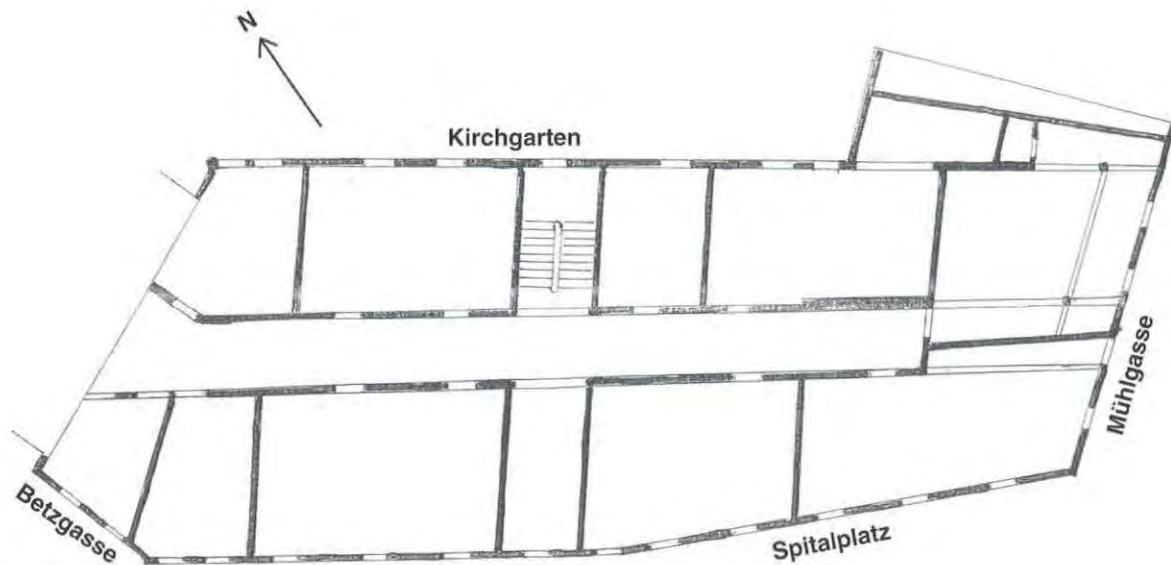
Pfründhaus 1916 – Grundriss 2. Stock (Bezirksbauamt Ludwigsburg, Zeichnung oben vereinfacht).
